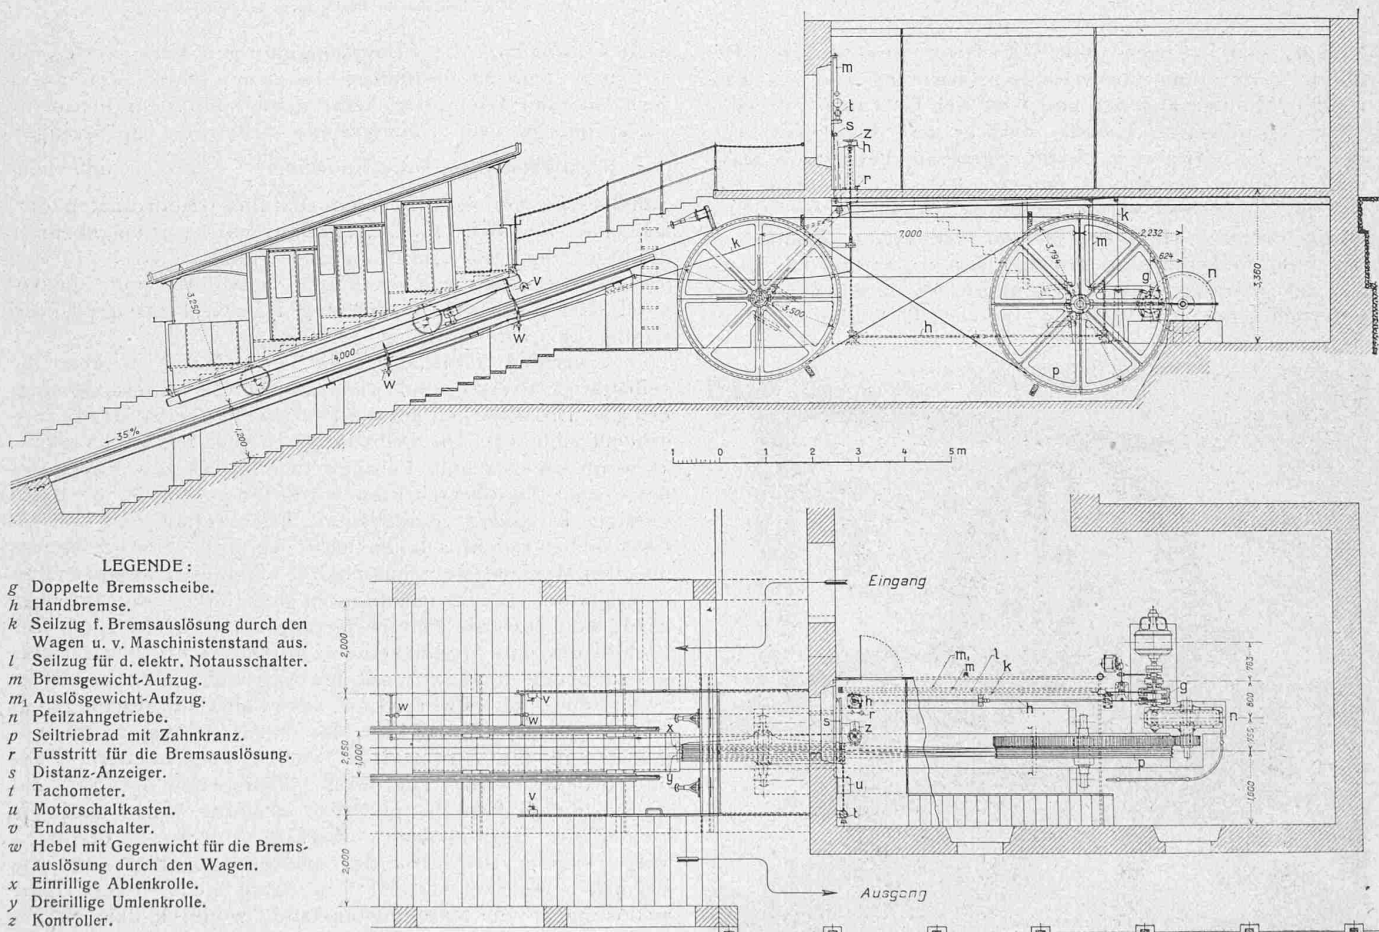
Längsschnitt und Grundriss der obern Station der Drahtseilbahn Treib-Seelisberg mit Triebwerk. — Masstab 1:150.
